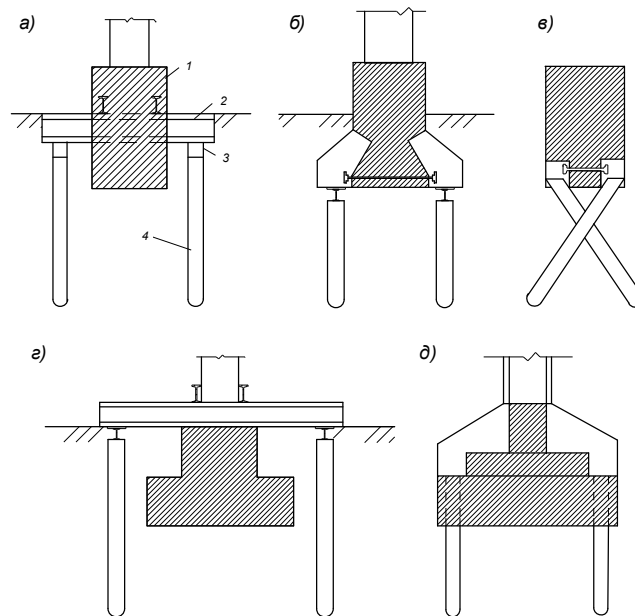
Варіанти підсилення фундаментів мілкою закладання набивними палями [37]:
